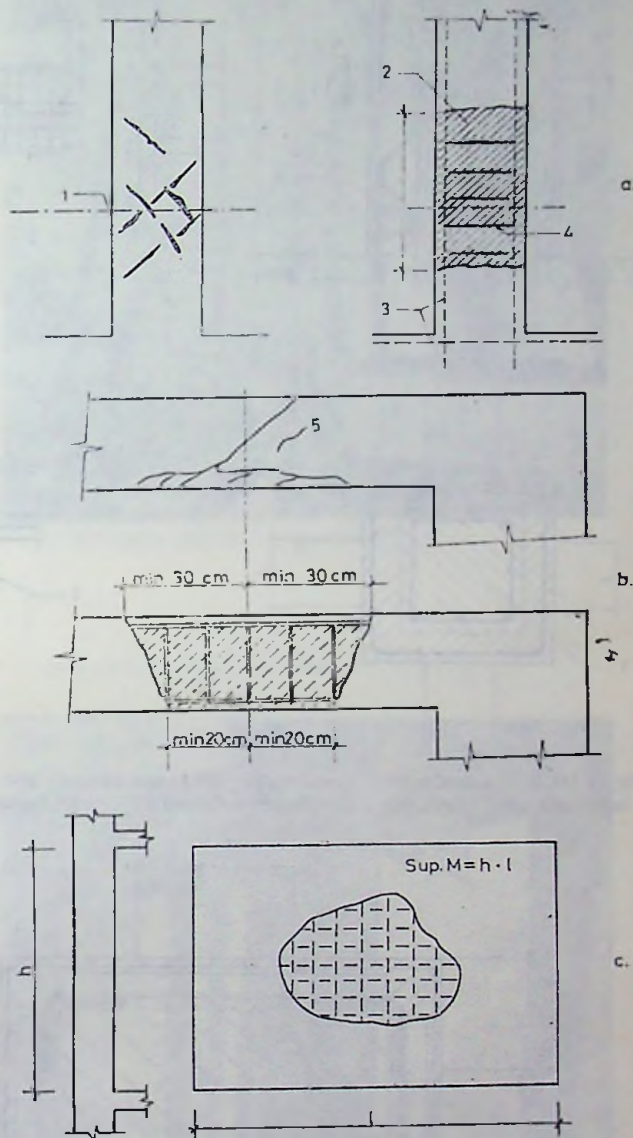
Remedierea prin rebetonare locală a elementelor de beton armat avariate (după document ONU [1]): a — Rebetonarea locală a unui stâlp; b — Rebetonarea locală a unei grinzi; c — Rebetonarea locală a unei diafragme; 1 — centrul de greutate al avariei; 2 — beton precompact; 3 — armături existente; 4 — armături de ranforsare; 5 — fisuri.
